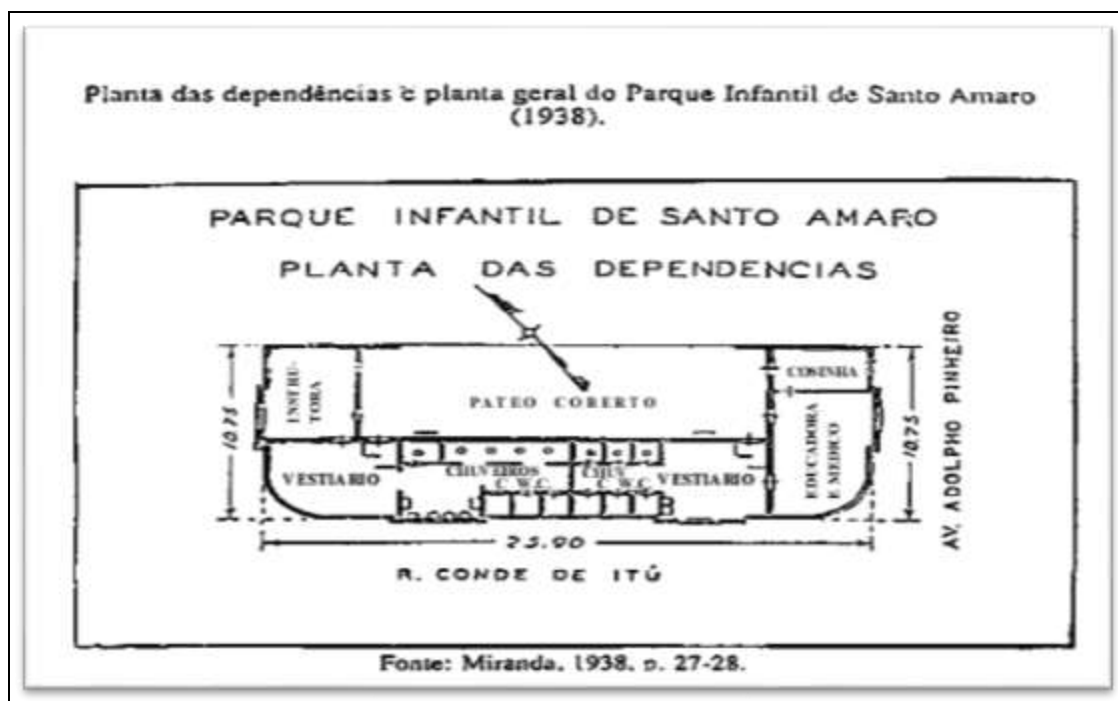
Planta das dependências e planta geral do P.I. Santo Amaro
